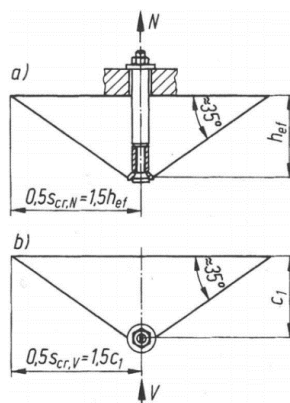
Vergleich Betonausbruchkörper unter Zuglast und Querlast, Elgehausen/Mallée 2000, 109
